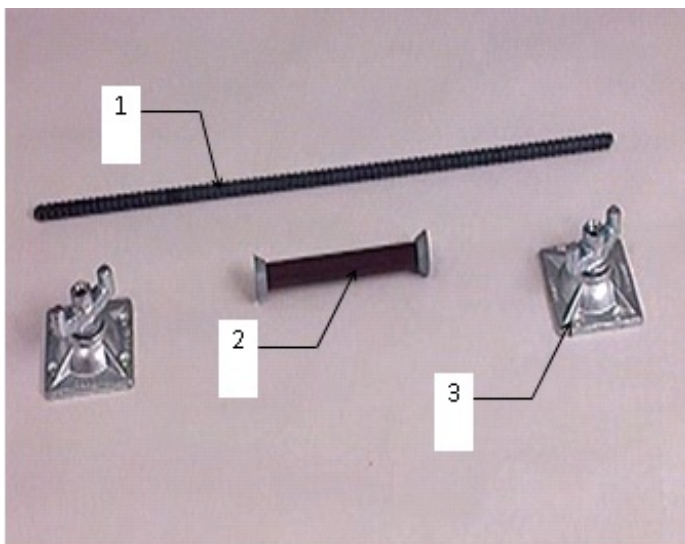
Элементы анкеровки опалубки: 1 – анкерный стержень – тяж; 2 – трубка ПВХ с конусами; 3 – гайка с расширенной платформой
